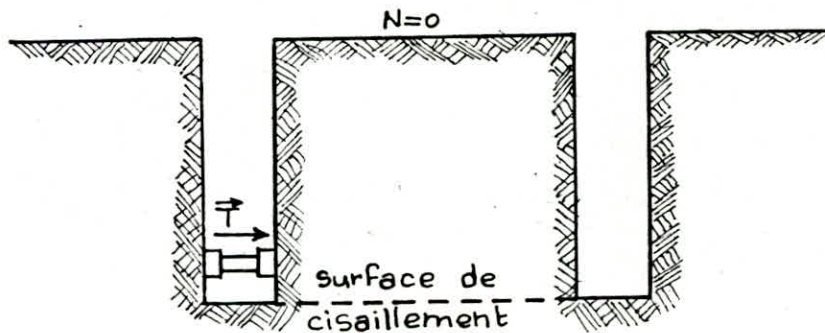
Essai de cisaillement in-situ sans compression ;
